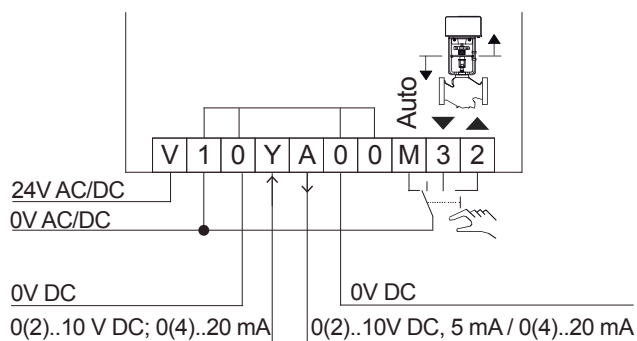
Handbetrieb mit Betriebsartenschalter (Auto / Halt / Zu / Auf)
